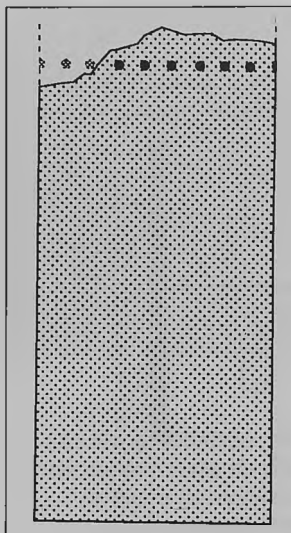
Castillo de Chodes: alzado frontal de la torre noreste con hilera superior de vigas para cadalso
